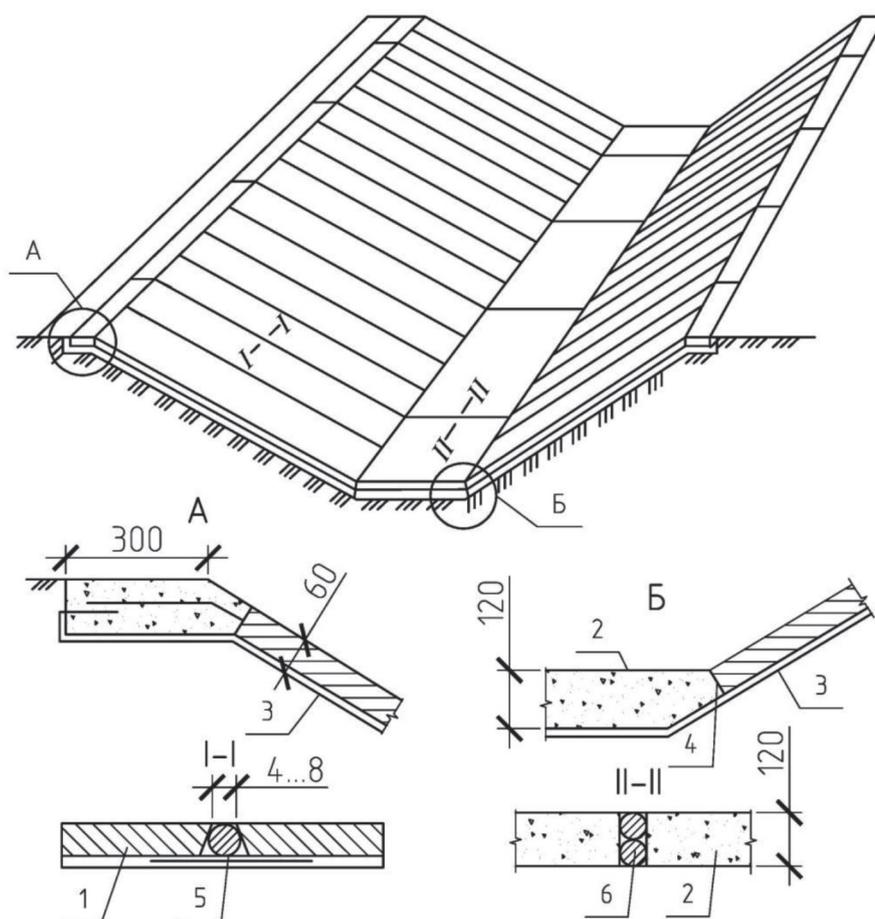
Крепление канала из сборного железобетона: 1 – сборная плита; 2 – монолитный железобетон; 3 – пленка ПВХ; 4 – битум; 5, 6 – заполнители швов
